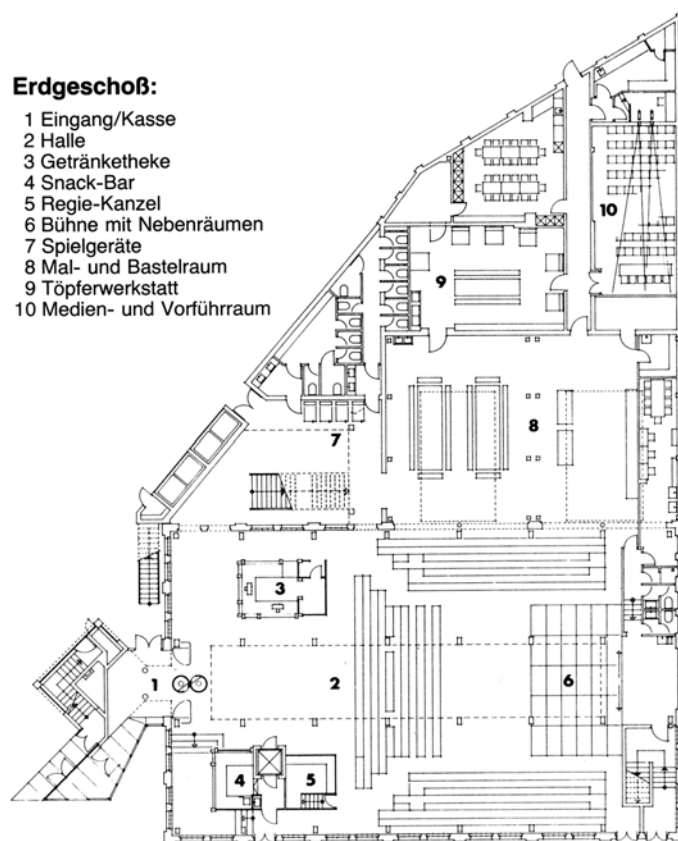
Fabrik*, Hamburg, Grundriß Erdgeschoß, nach dem Umbau 1977
